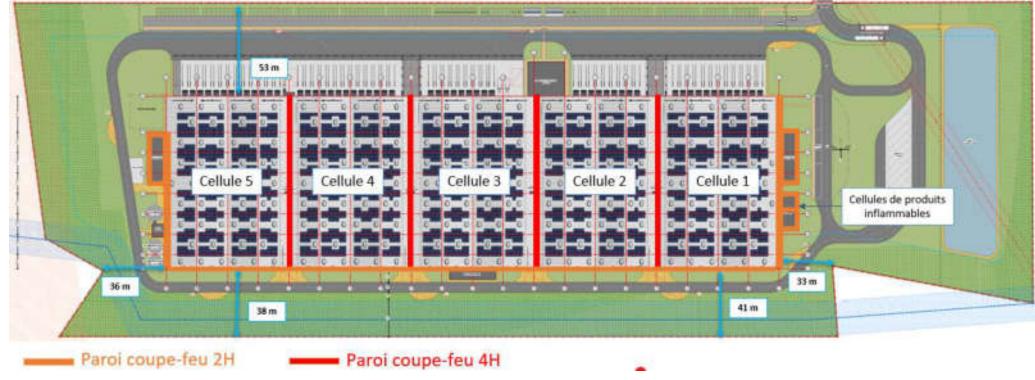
Plan RDC du bâtiment : vue générale avec recoupements coupe-feu 2 h et 4 h
